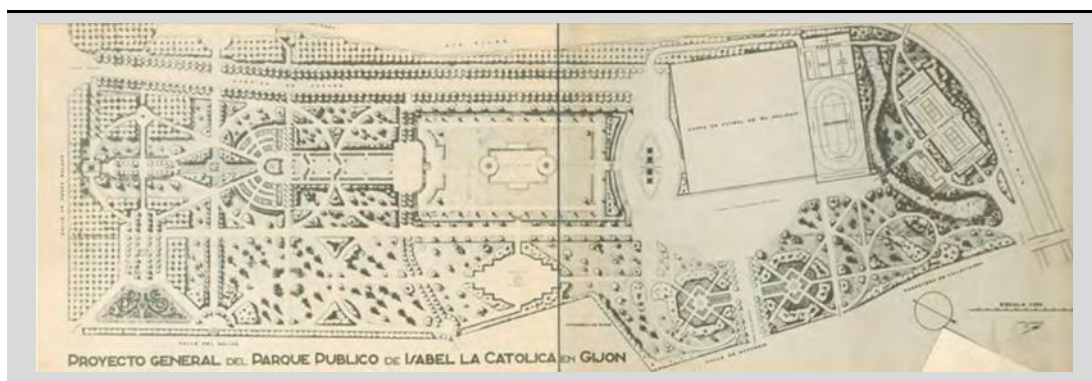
Plano Original del Parque de Isabel la Católica.
